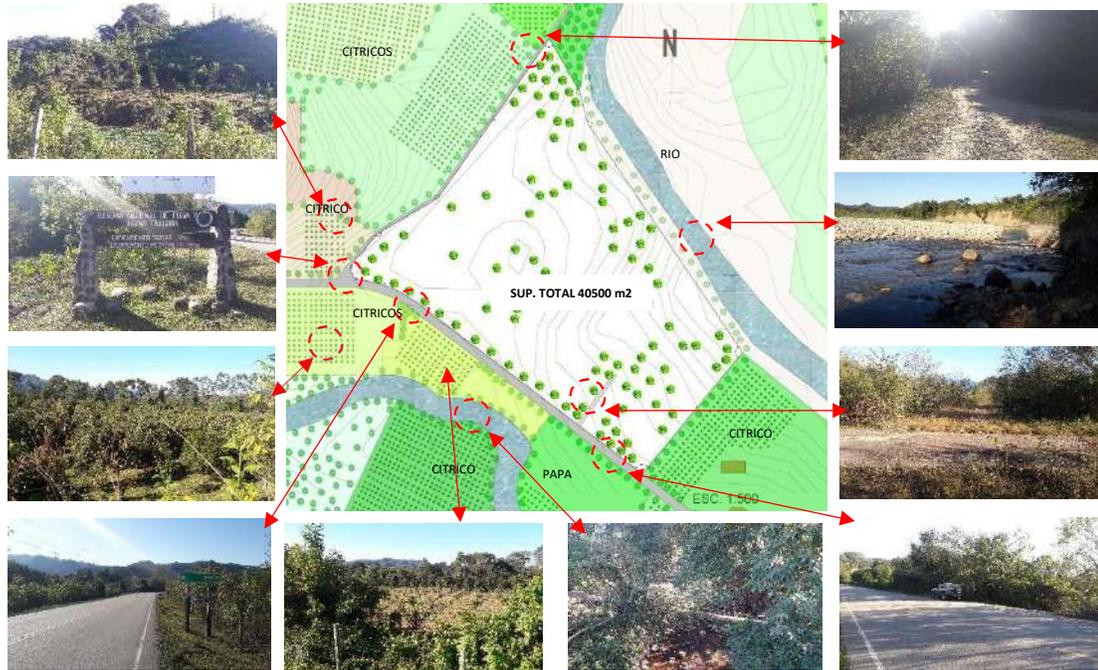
; Fuente propia plano de emplazamiento con radio de 50m .
